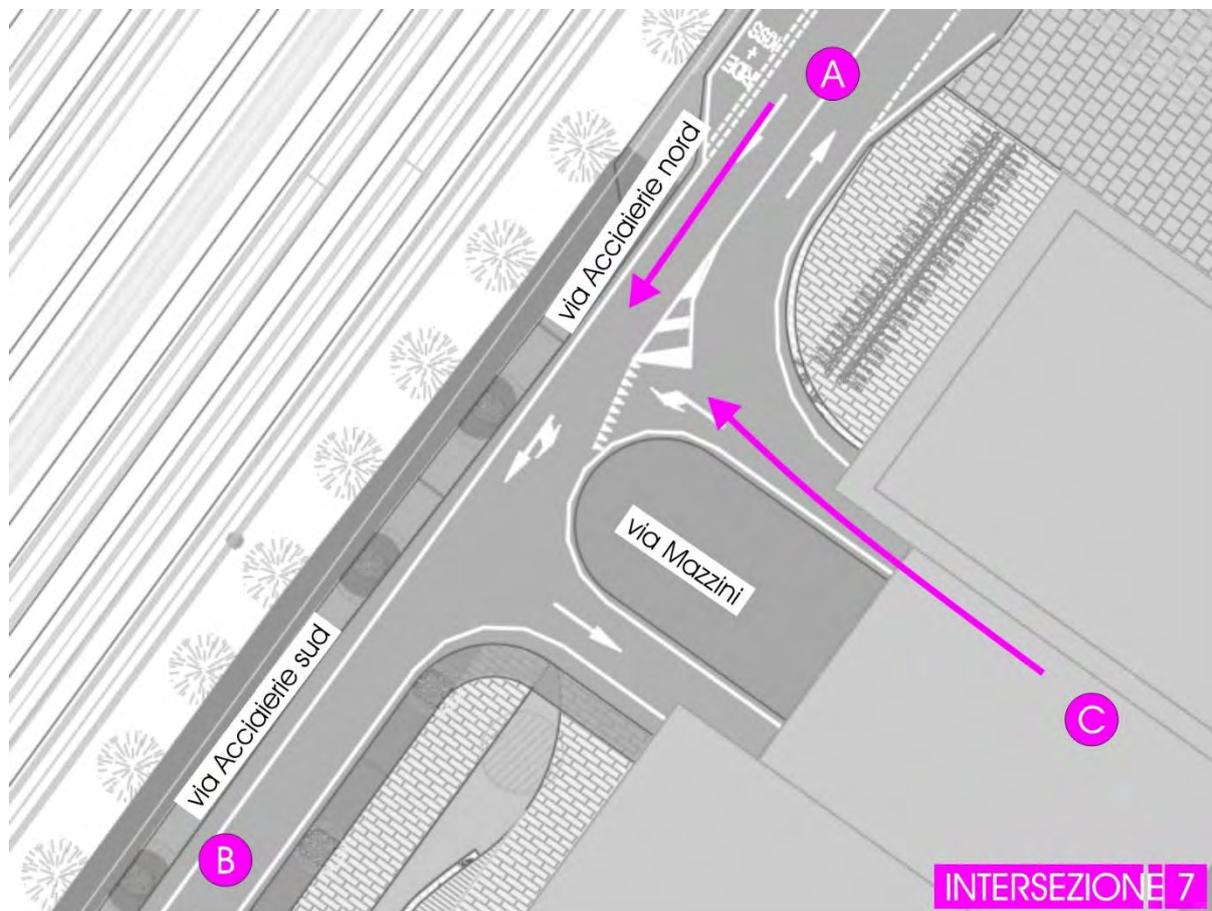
Scenario di Intervento 1 – Planimetria intersezione 7
